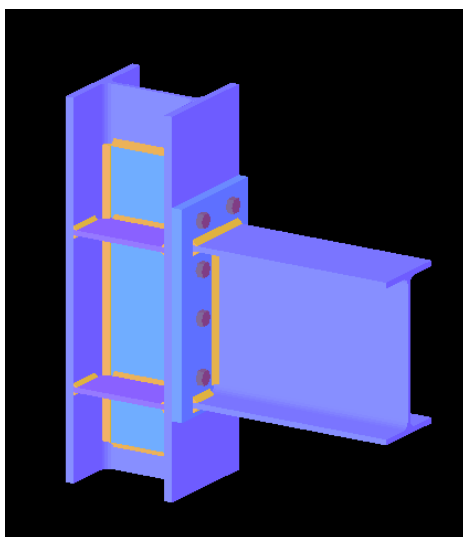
Ligação reforçada com chapa de alma e placas transversais no pilar
